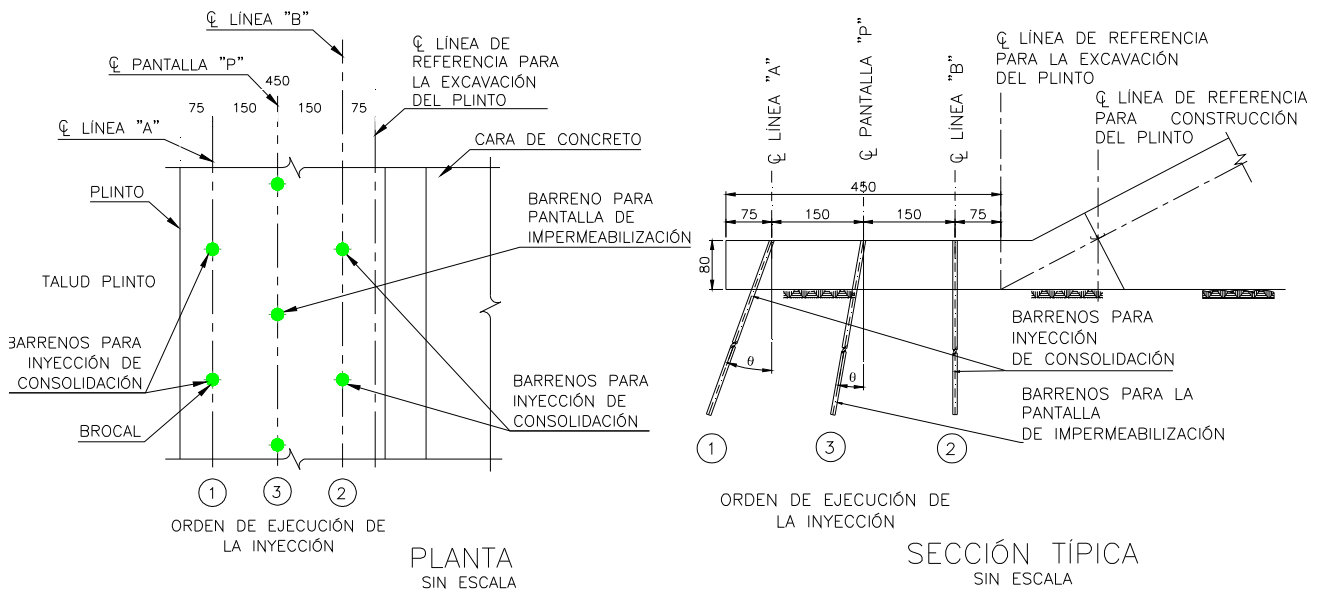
Planta y sección del Plinto y distribución de los barrenos de inyección en el tramo P11'-P12.
